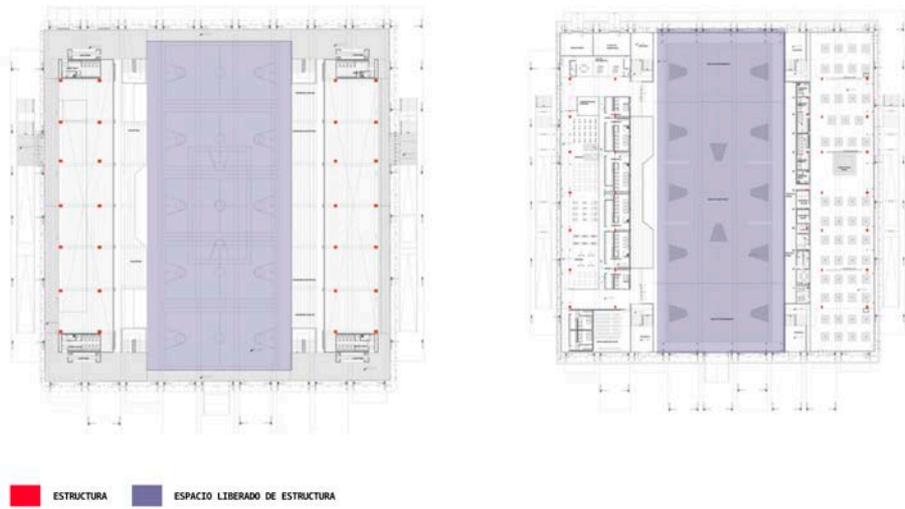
Estructura Coliseo de Medellín. Ilustración propia. Planos cortesía de equipo mazzanti
